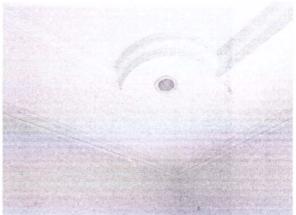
Fissura em Detalhe do Gesso e detalhes Lâmpada com Defeito
